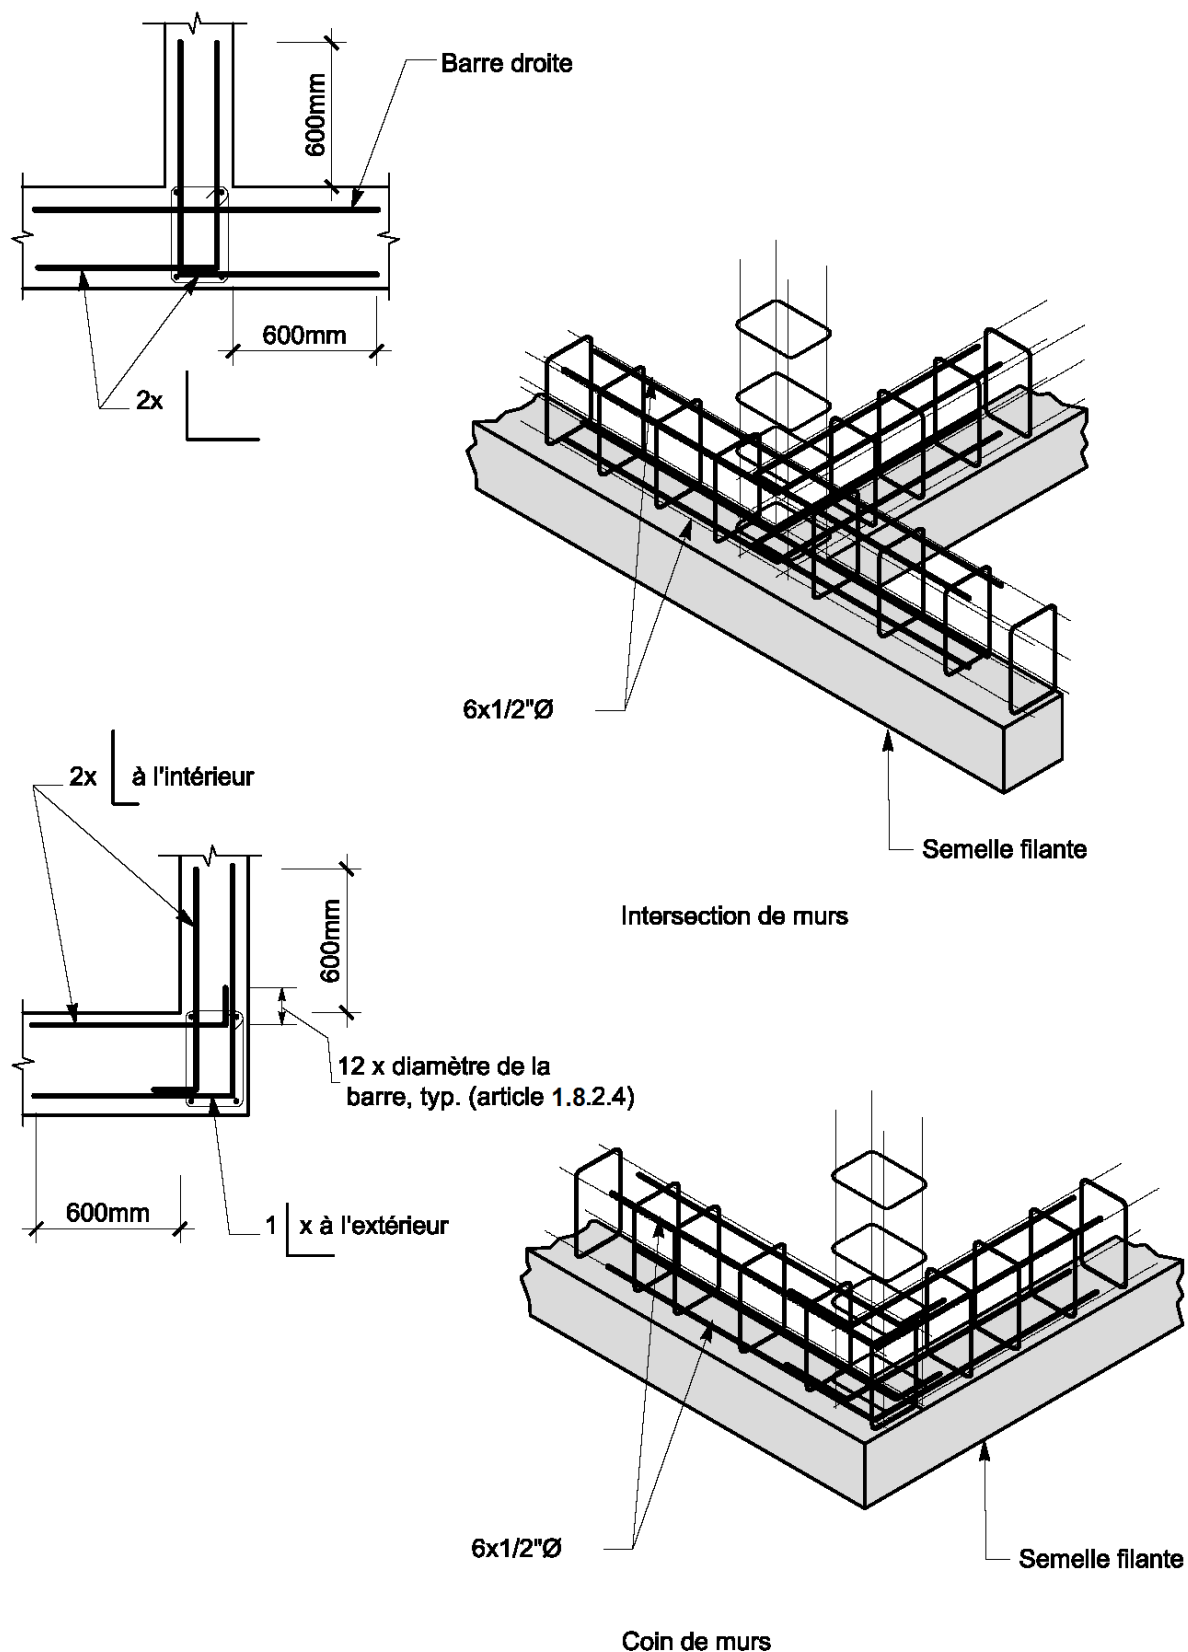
b - Jonction chaînages horizontaux-chaînage vertical aux coins et intersections de murs
